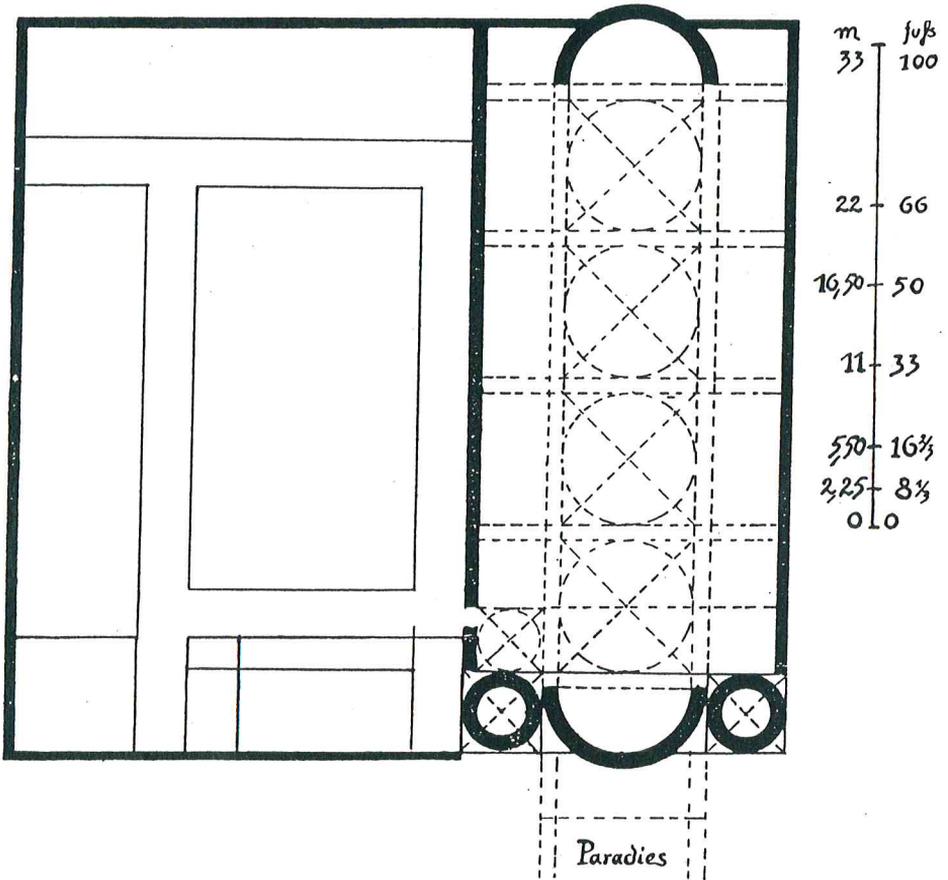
Metten. Rekonstruktion des romanischen Grundrisses (nach Fink 1937 [Anm. 3] 237 Abb. 2).
